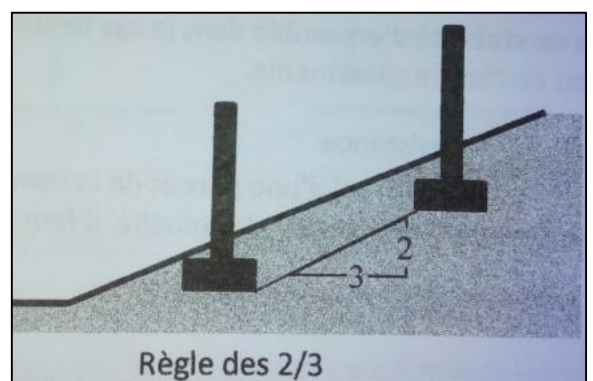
Règle 2/3, implantation des fondations sur un terrain en pente.
